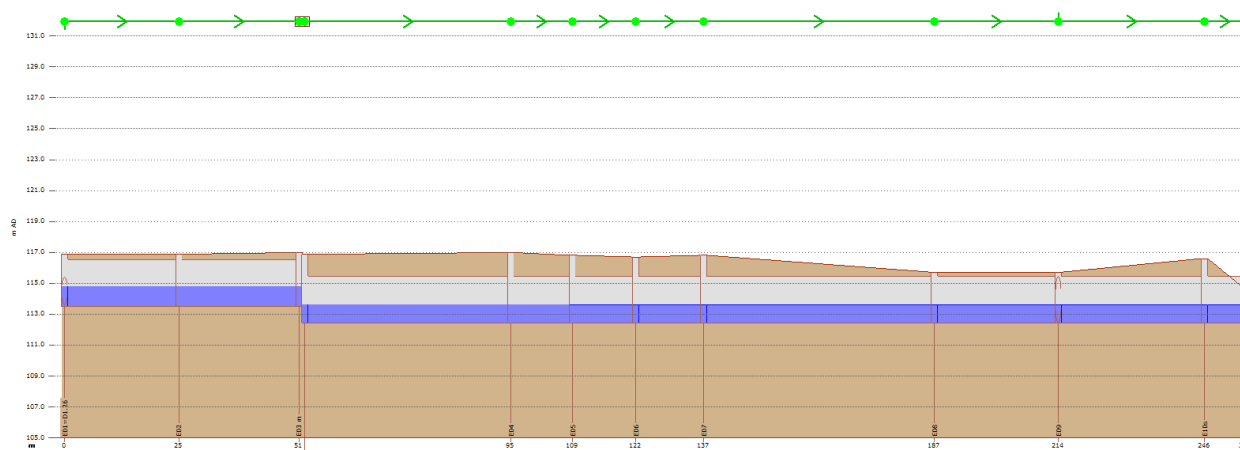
“Tratta E – Planimetria: canale in via Conca del Naviglio da via d'Oggiono alla Darsena”
